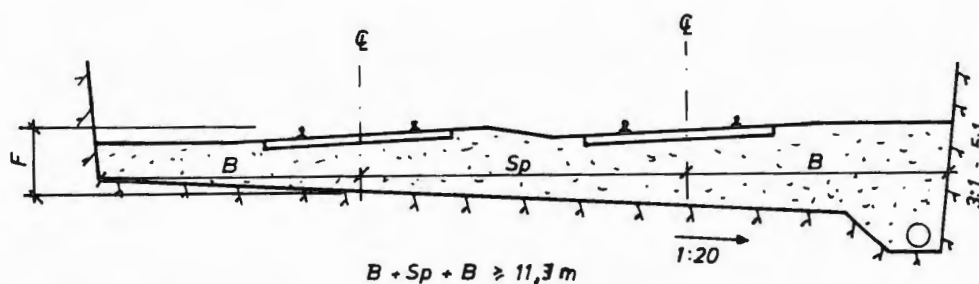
Minimum planeringsprofil i fjellskjæring.
